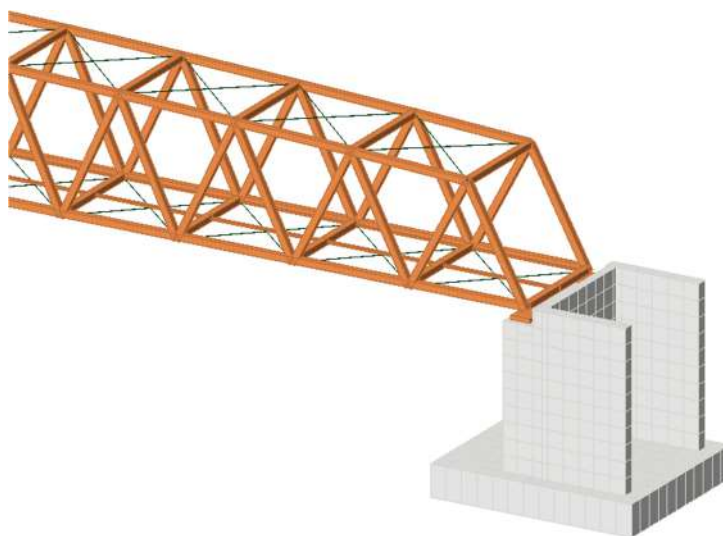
Rendering strutturale – particolare spalla B
